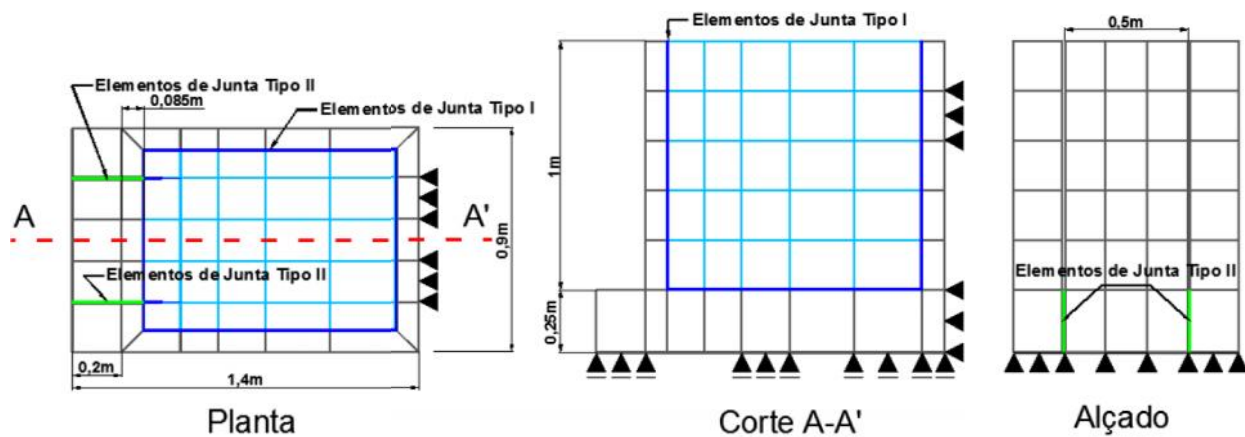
Planta, corte e alçado da malha do tanque utilizada no programa de cálculo DySSA 1.0.
